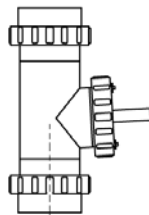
Élément d'inspection sur conduit vertical.
